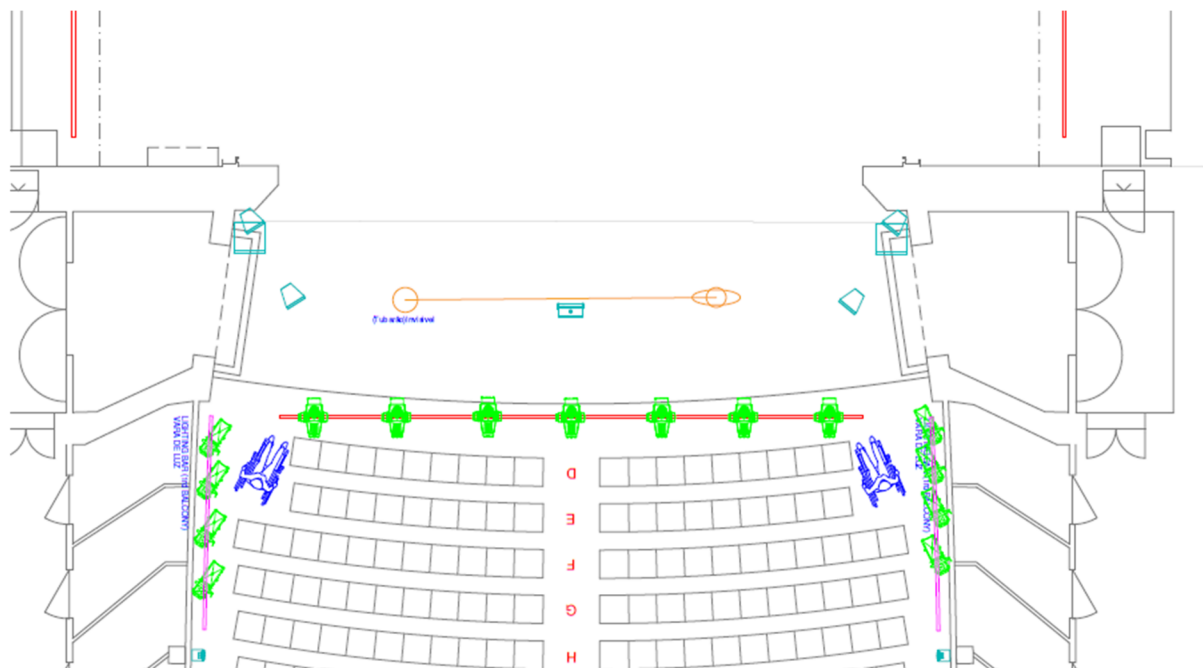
Planta do fosso de orquestra do TNSJ (SketchUp)
